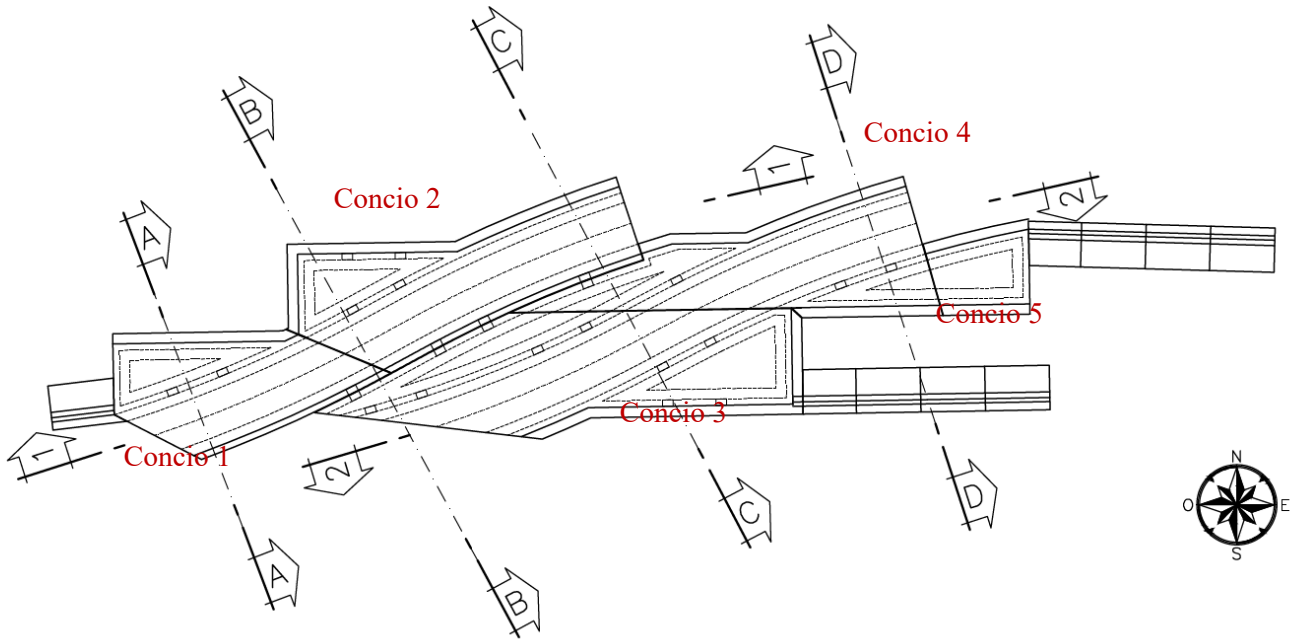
GA01 – Galleria Europa 1 - Stralcio planimetrico
